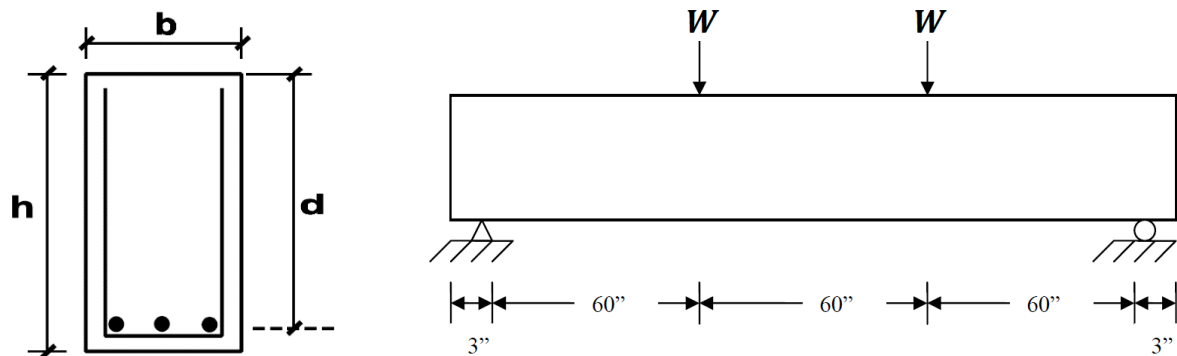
Dimensões em in da viga ensaiada por Foley & Buckhouse (1998).
